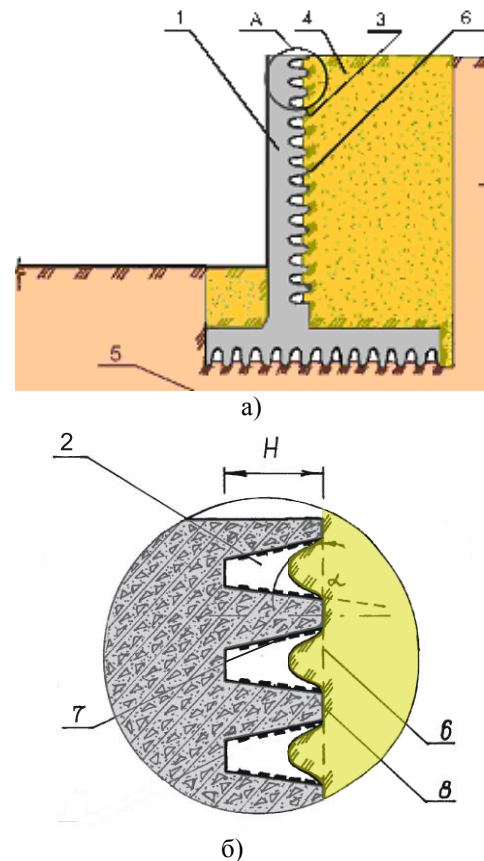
Підпірна стінка кутникового типу з порожнинами: а) загальний вигляд; б) вузол А
